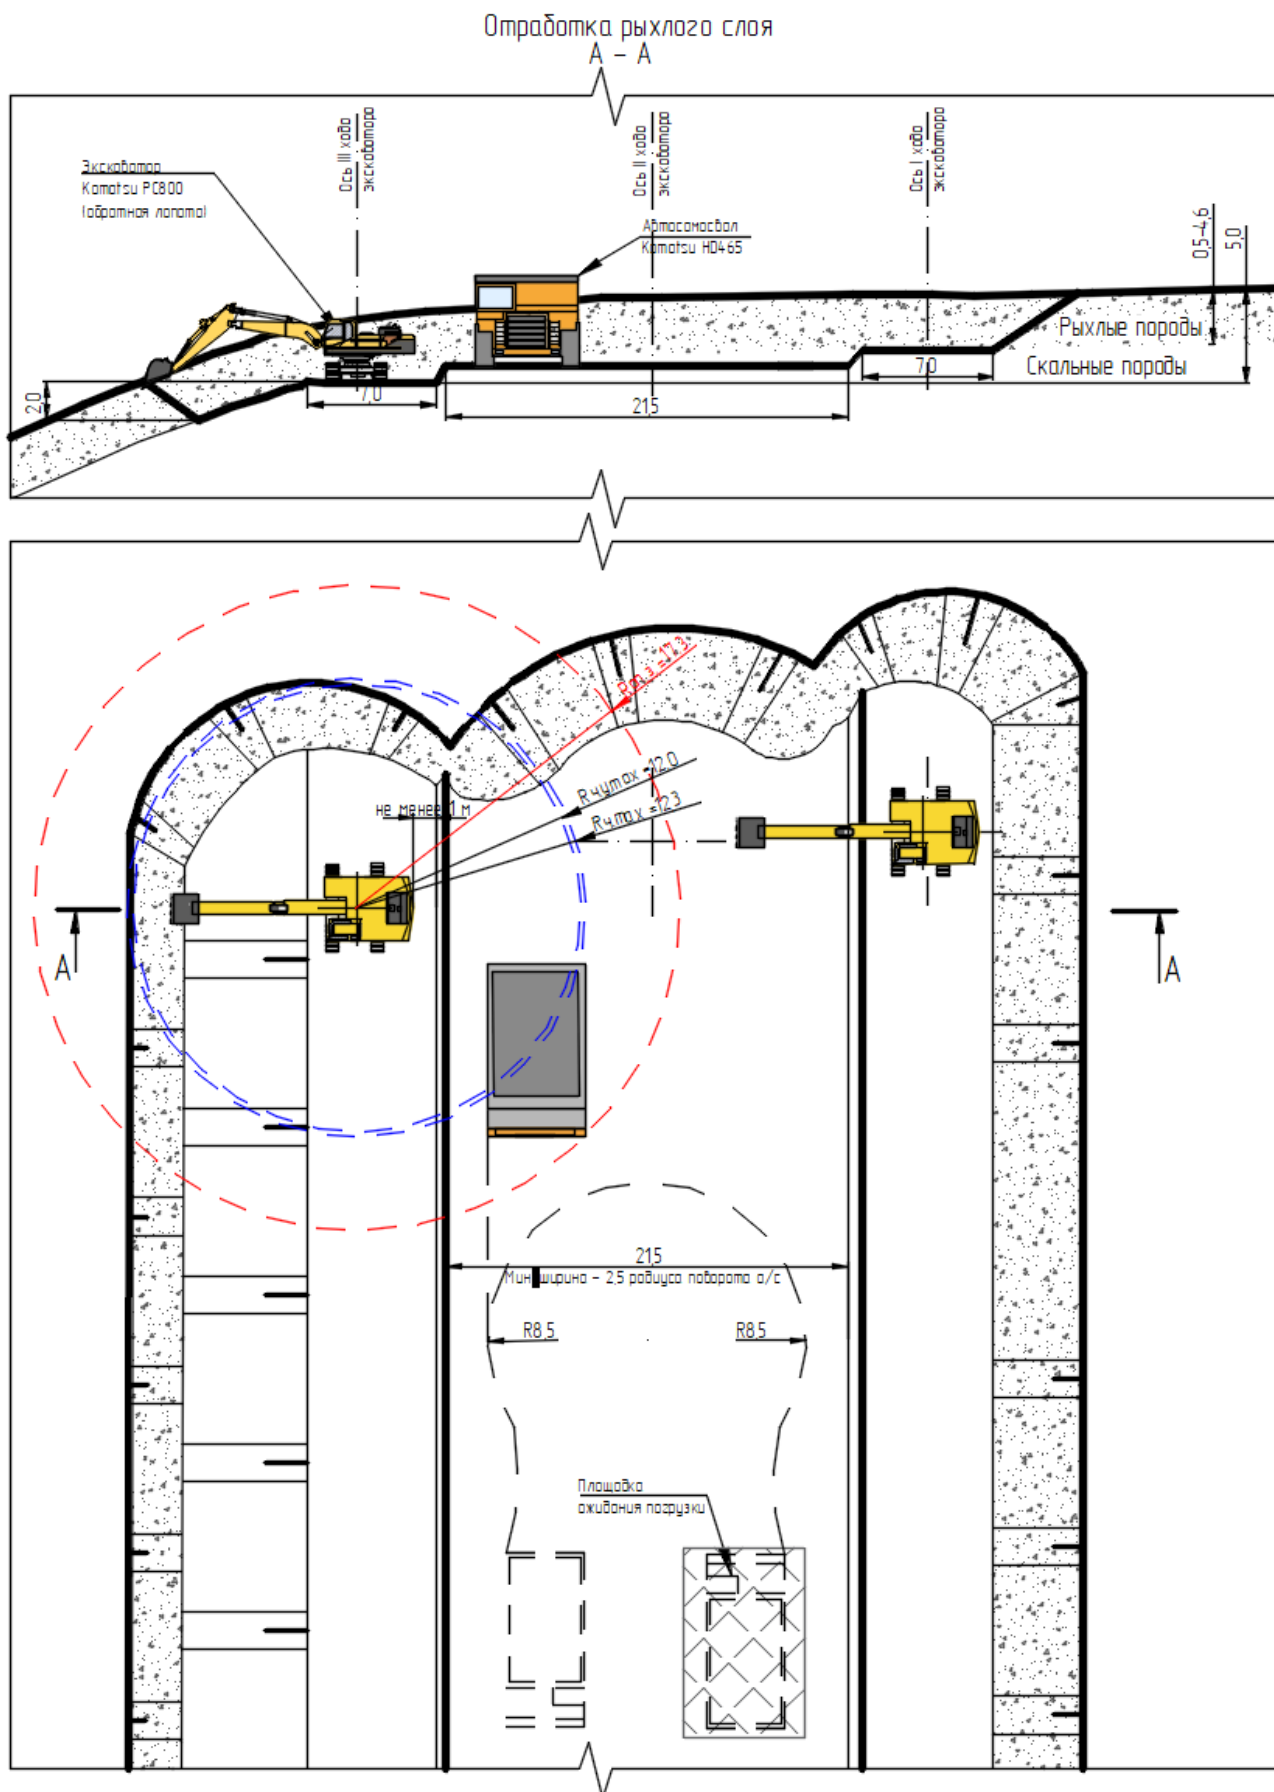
Схема снятия рыхлого слоя при создании первоначальной рабочей площадки
